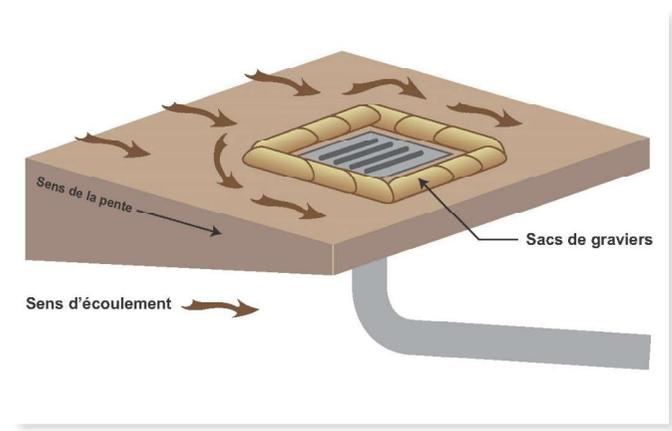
Exemple d'une protection de bouche d'égout : barrière périphérique en sac de graviers.
